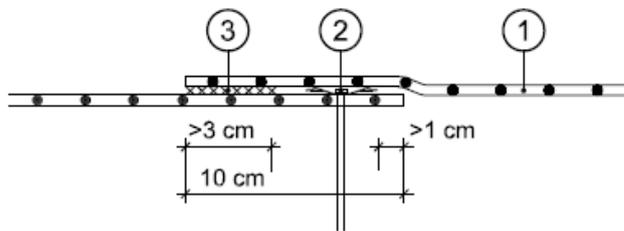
Cas d'un pare-vapeur bitumineux sur élément porteur en maçonnerie
